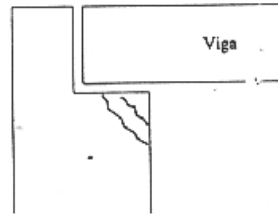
FISSURAS na cabeça de pilar
